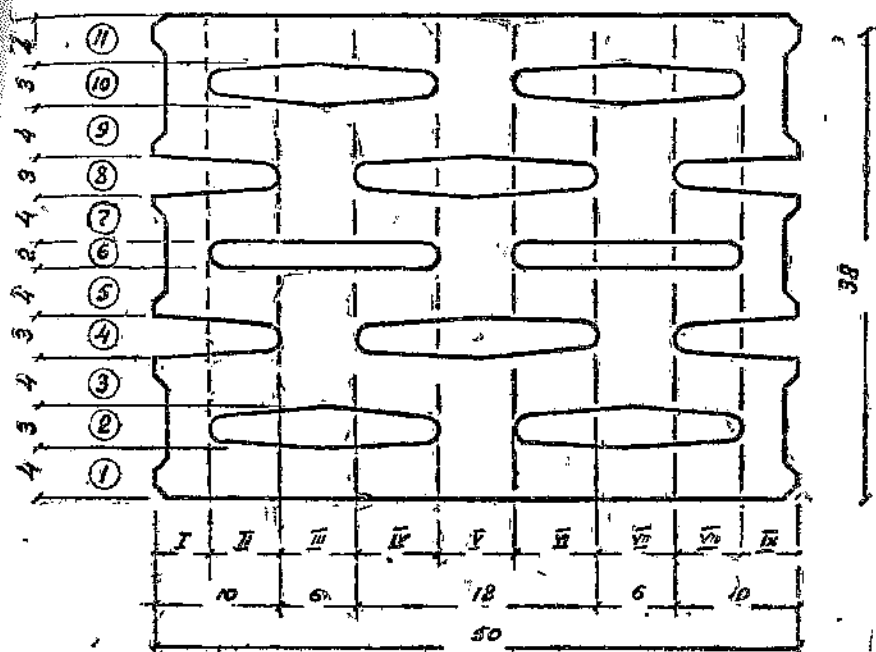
К теплотехническому расчету стены из блоков „Крестьянин“ (50×38×20 см)
